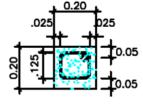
Detalle de Viga Asísmica con sus dimensiones
